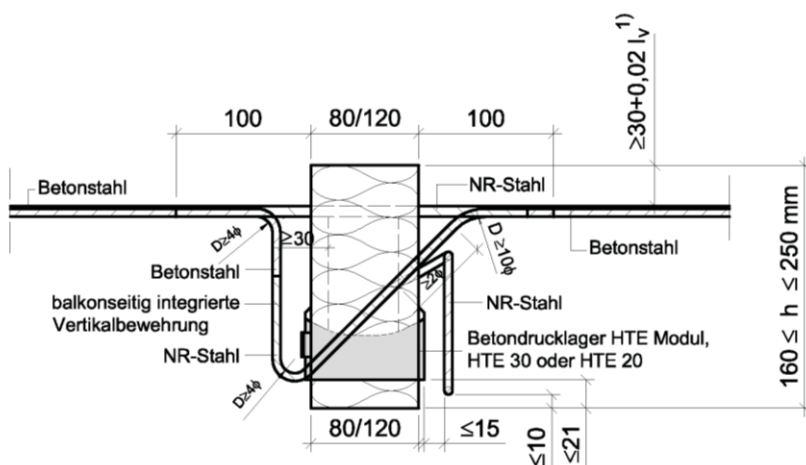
Schöck Isokorb Typ RK-240 mit Sonderbügel
